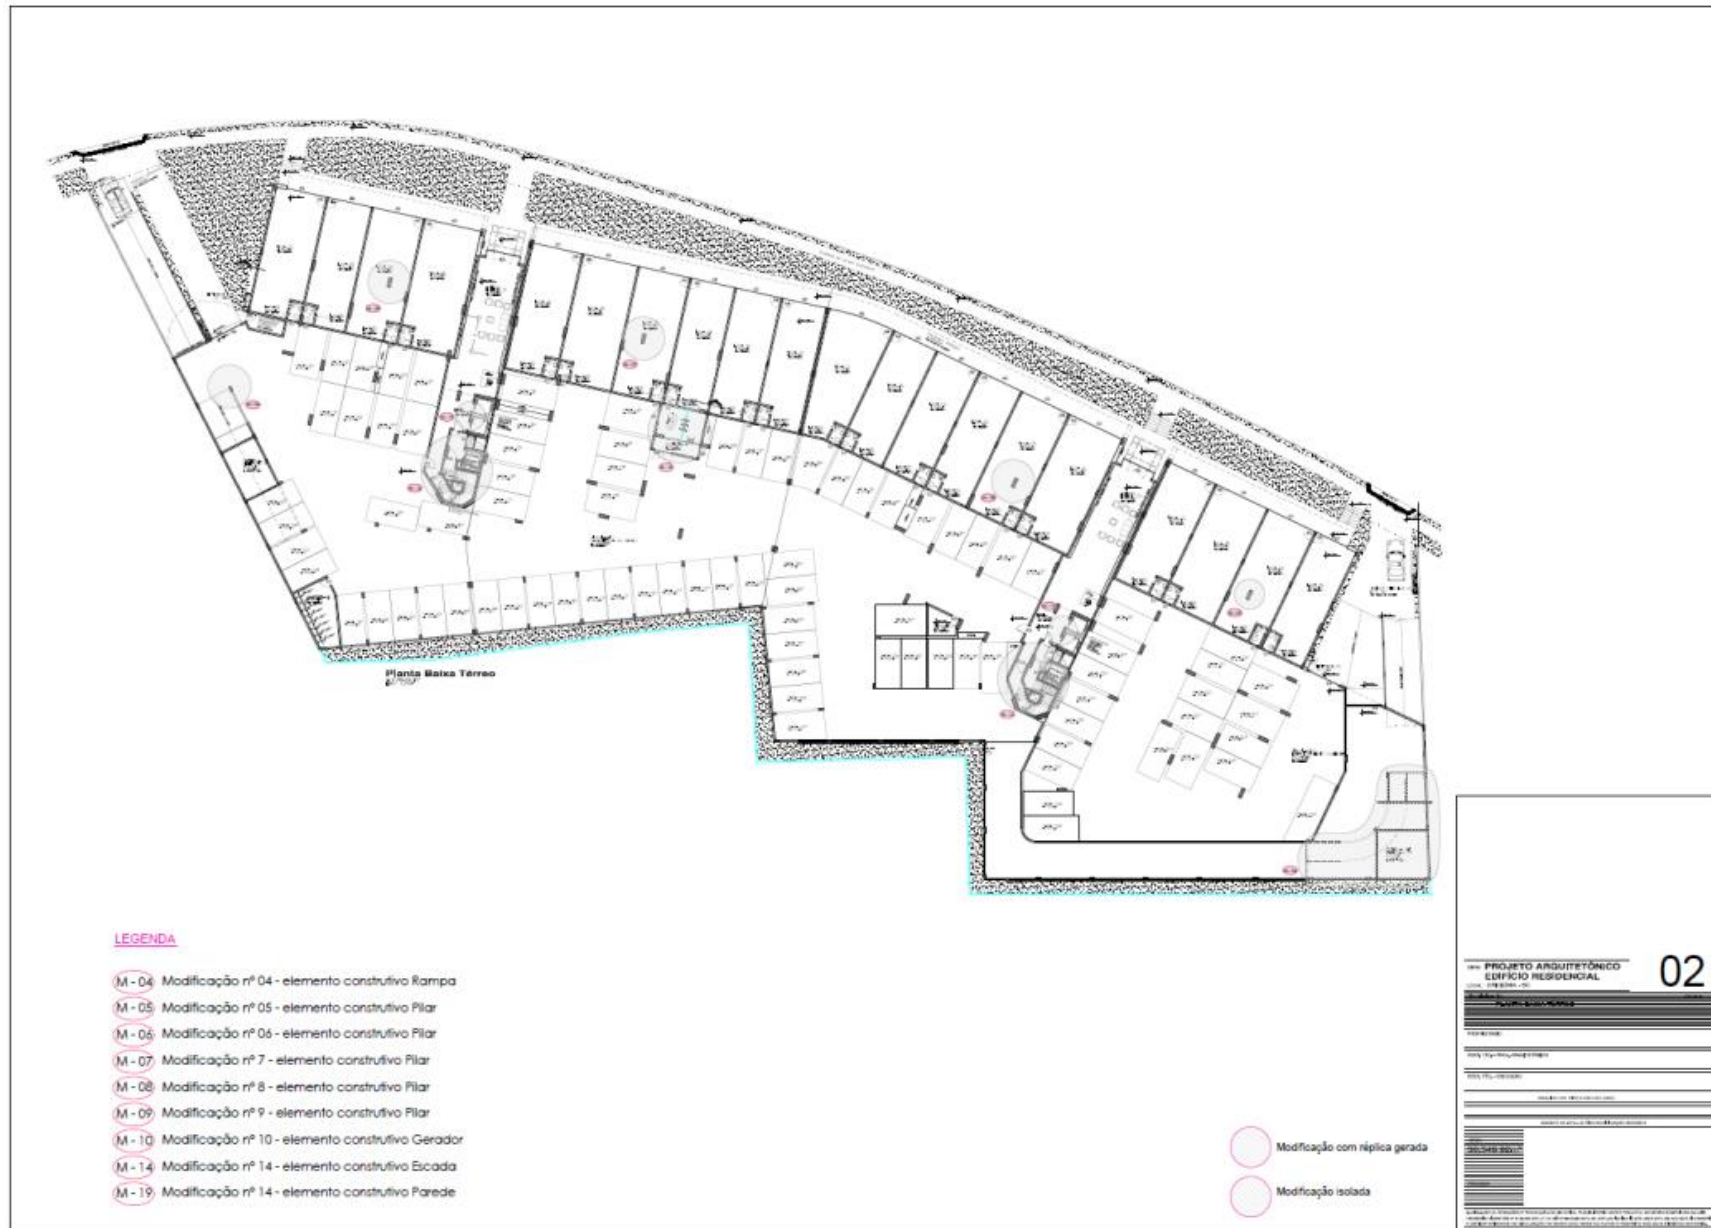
E.C. 02 planta baixa do pavimento térreo.
